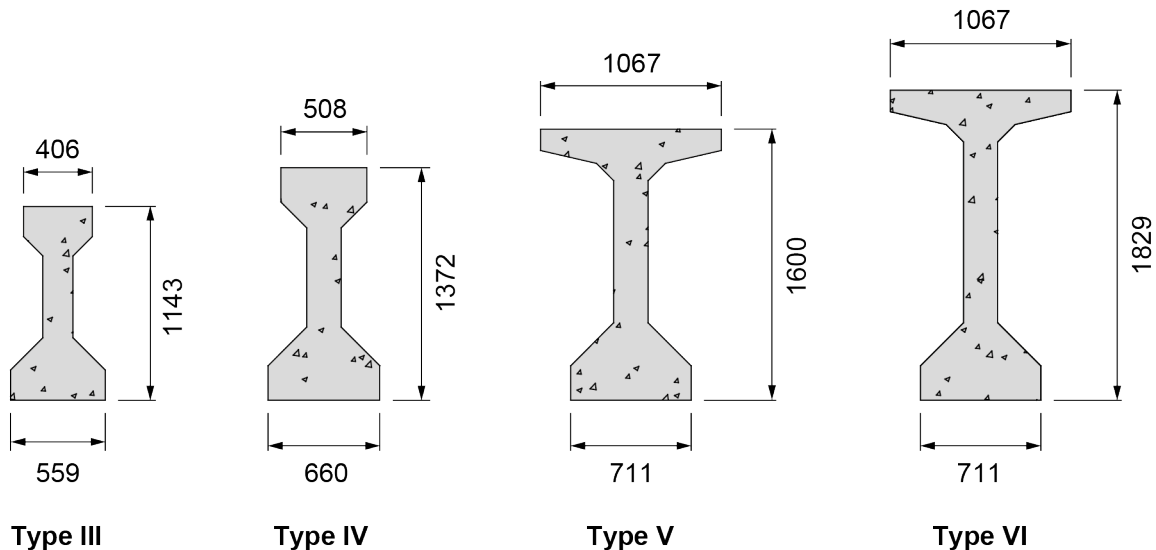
Poutres en béton précontraint préfabriqué de type AASHTO
